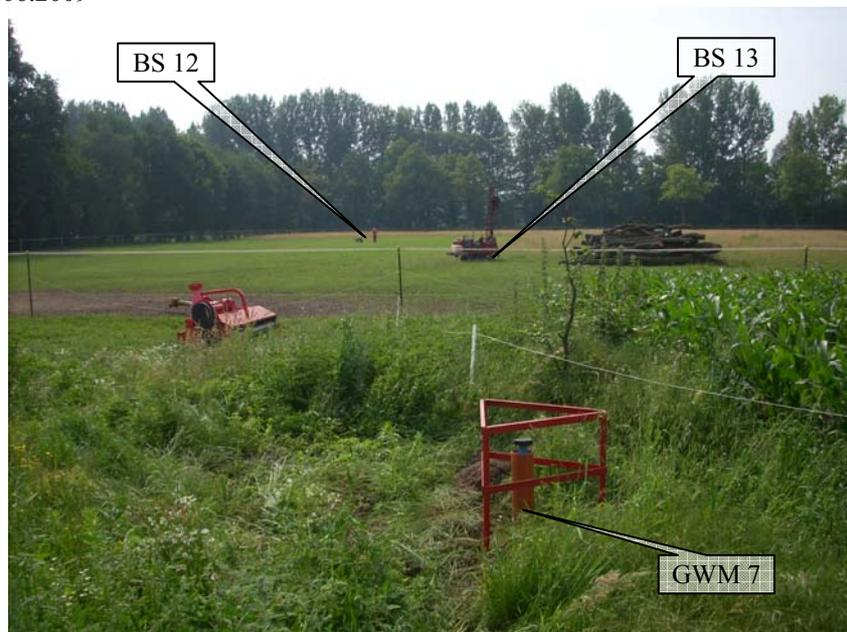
Blickrichtung ~ SO; Bereiche der BS 7 (Markierung); ausgebaut zur Grundwassermessstelle GWM 7, der BS 12 (Markierung) und der BS 13 (Markierung)
